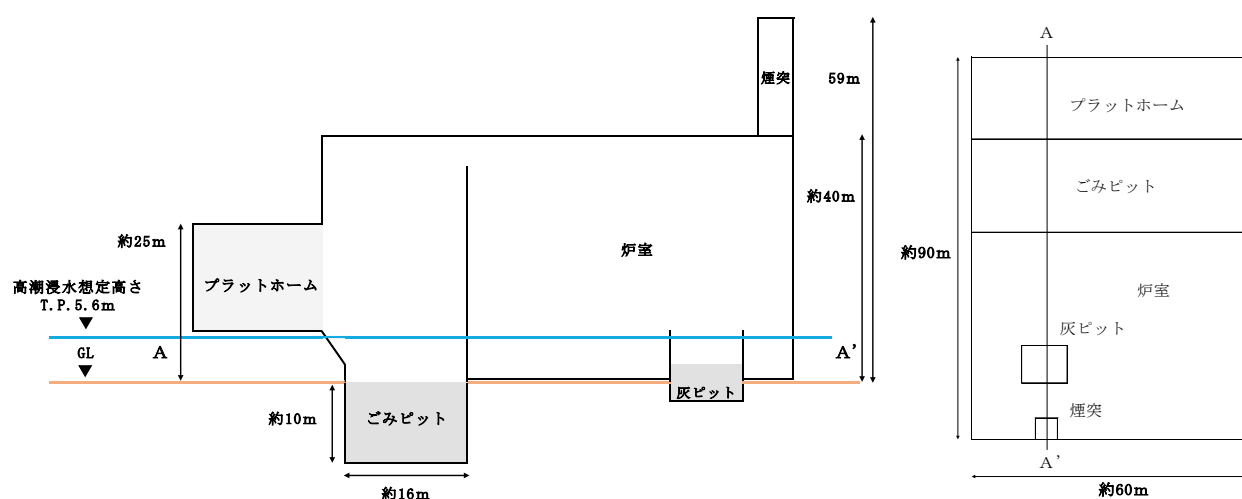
ごみピットの計画断面図及び平面図の一例
